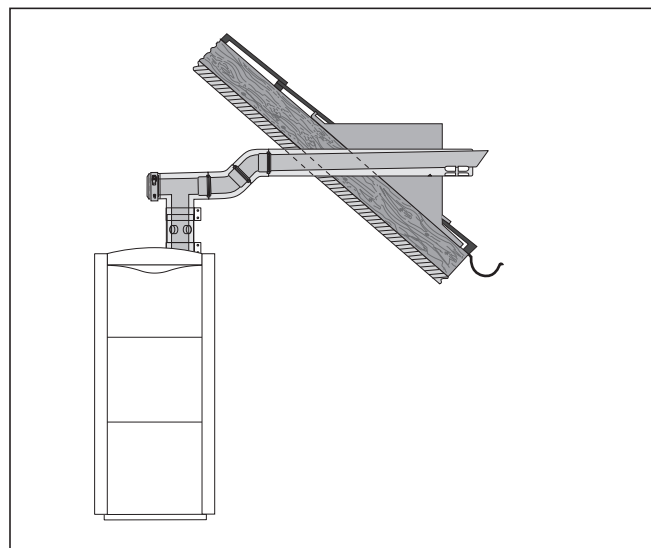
Exemple de montage d'une traversée de mur/toit horizontale avec pièce en T d'inspection.
